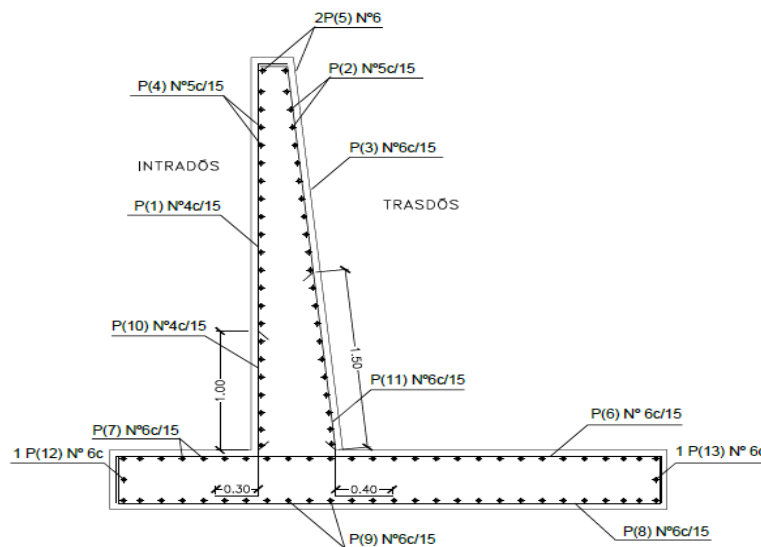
Armado de muro encole-La Culebra. Elaboración propia
